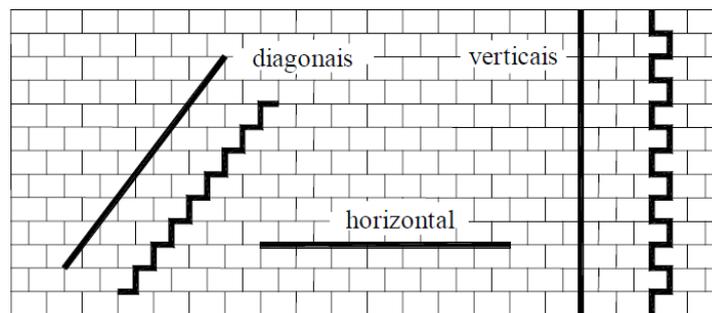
configurações básicas das fissuras. (HOLANDA JR)
